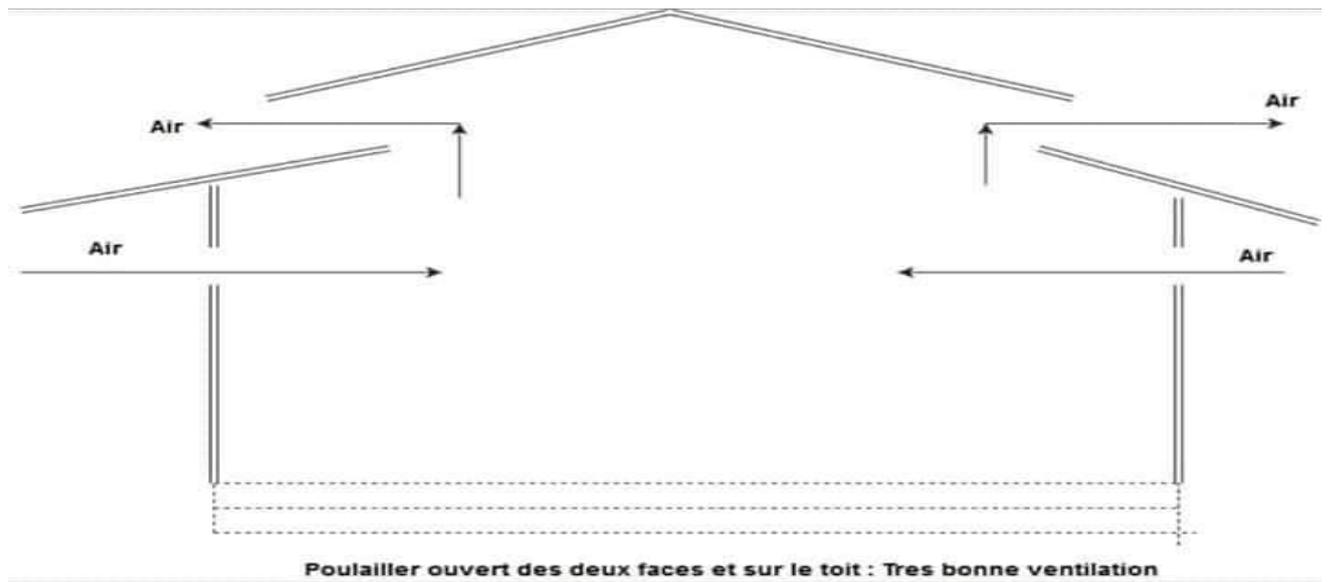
plan du bâtiment d'élevage ouvert des deux faces et sur le toit (Anonyme).
